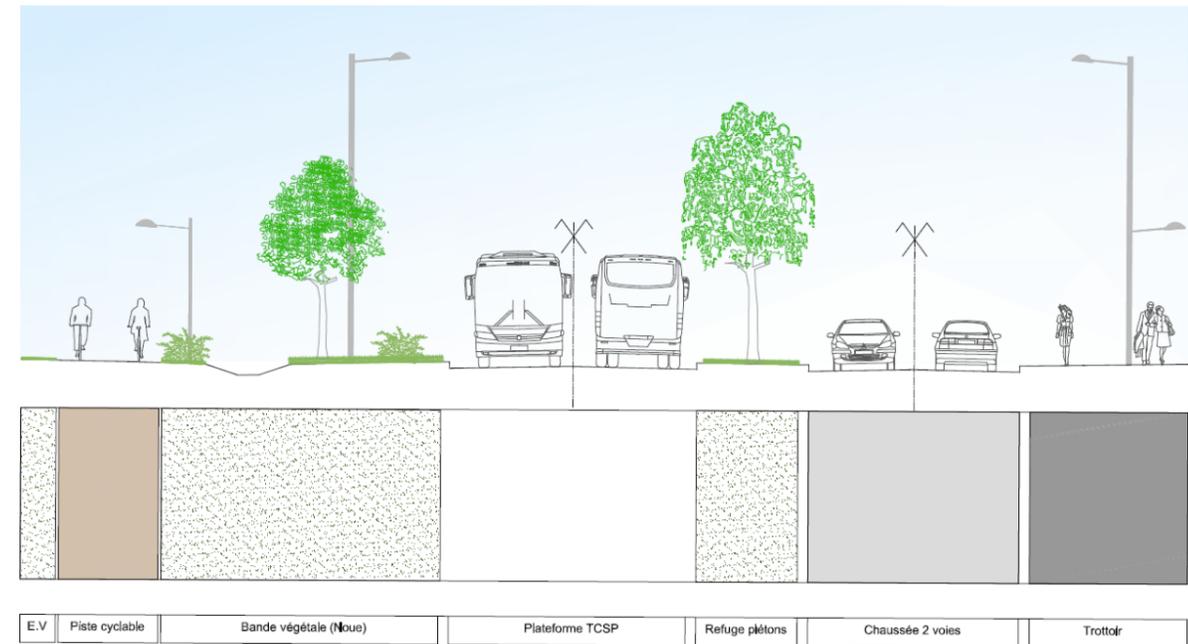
Coupe de principe sur le Boulevard Ouest – Section 1
